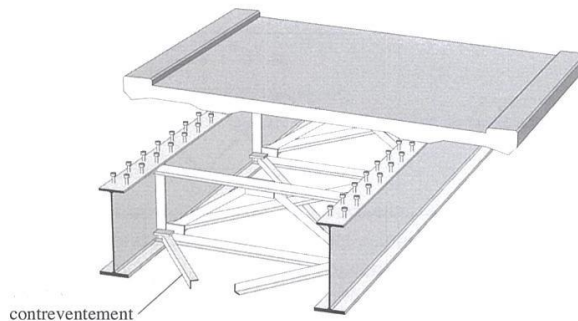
Section mixte ouverte munie d'un contreventement inférieur.
